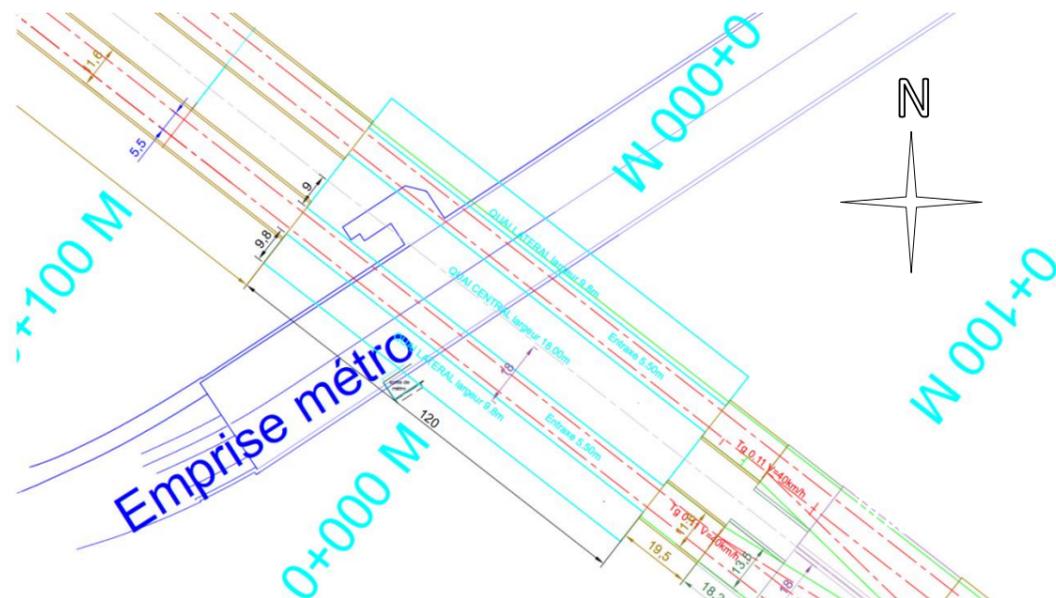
Plan d'implantation de la future Gare LRF de Lille-Flandres
